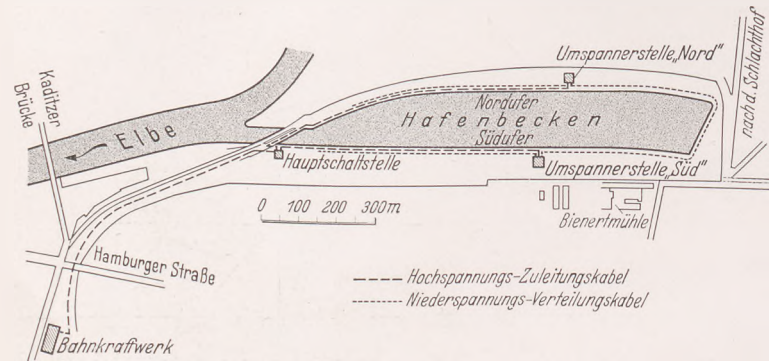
Lageplan des König Albert-Hafens mit den neuen Leitungen.
